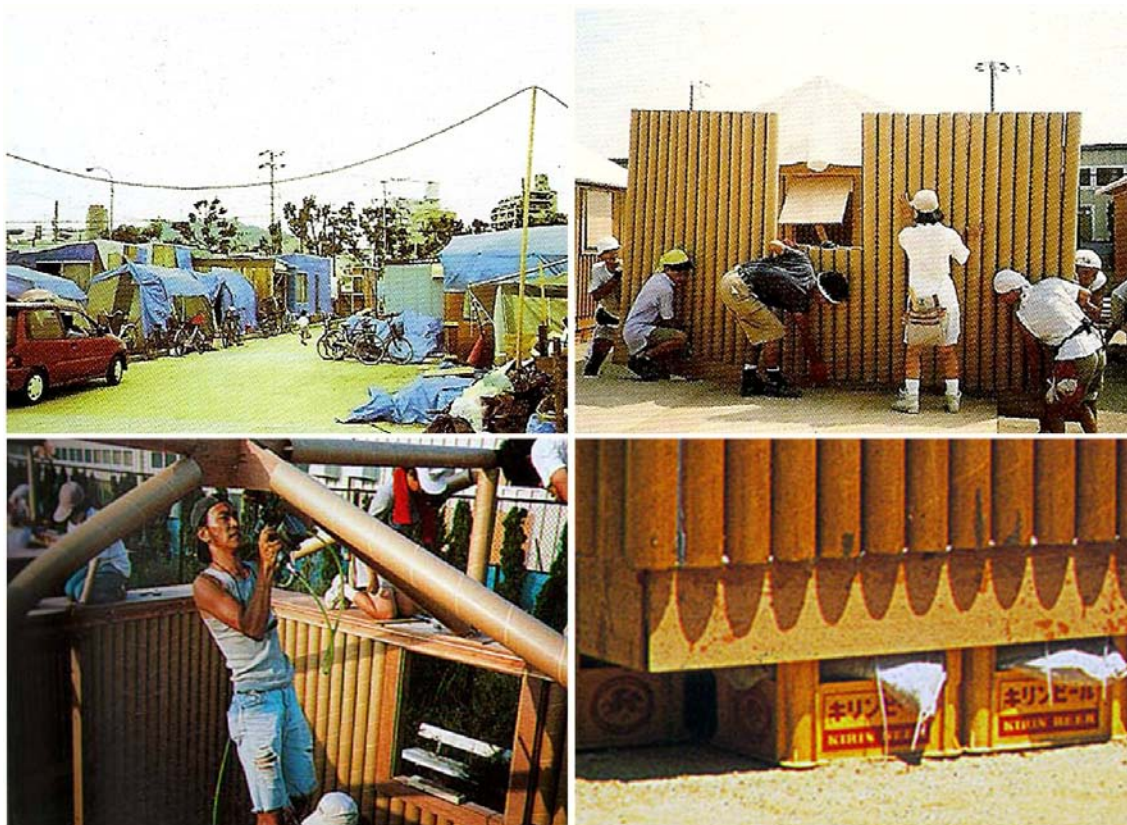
Tendas onde as vítimas viviam. Fases da construção da Paper Log House. E pormenor das fundações.
